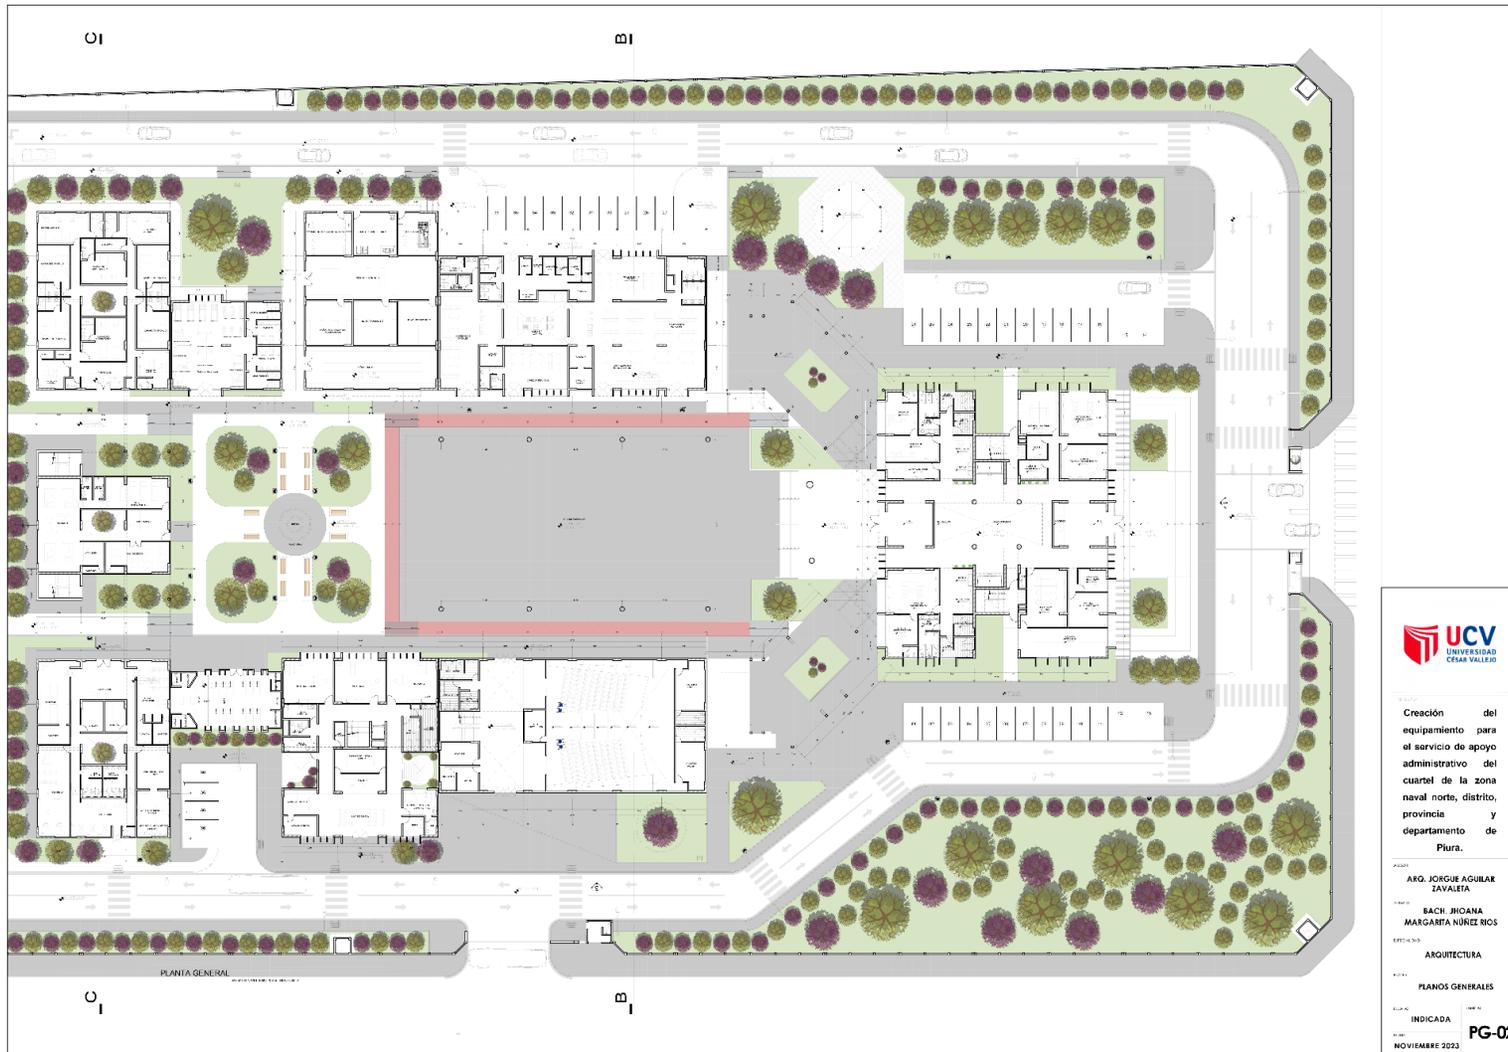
Planos Generales - Plano genera del primer nivel – SECTOR 2
